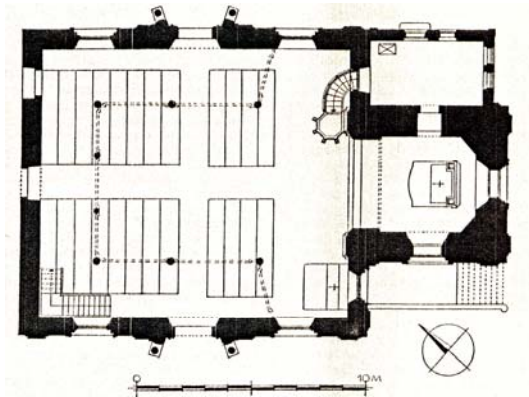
Kulmbach, Spitalkirche Grundriss
